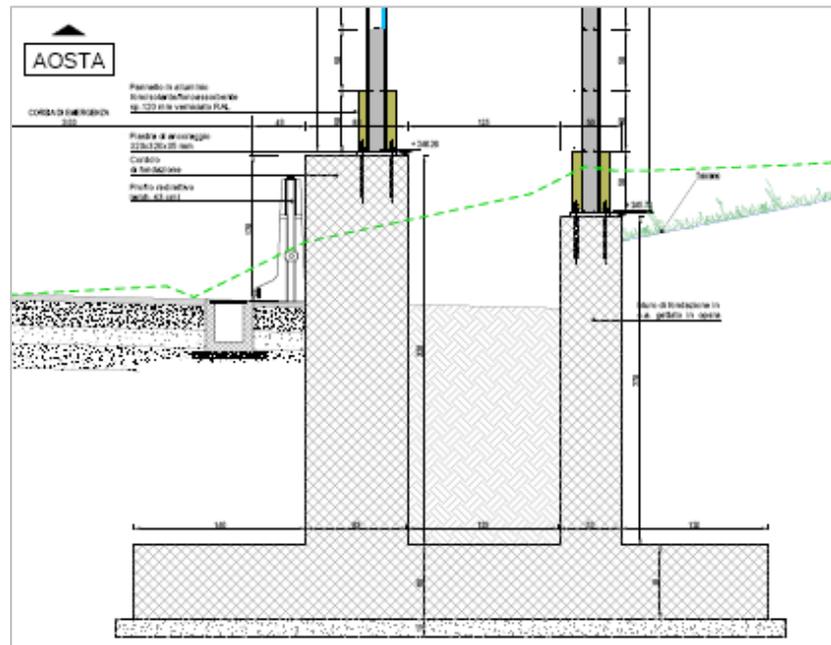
/5 Tratto di raccordo fondazioni tipo 1-tipo 2 - Sezione
